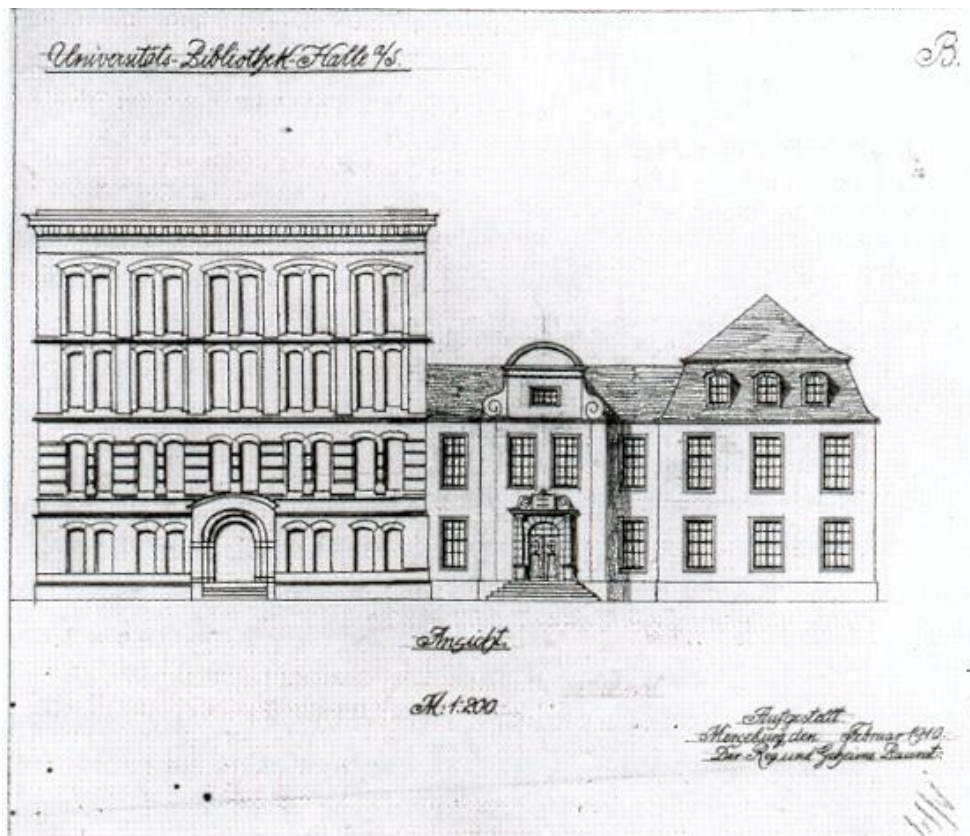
Friedrich Beisner – Entwurf zu einem Erweiterungsbau, Aufriss der Westfassade, 1910
